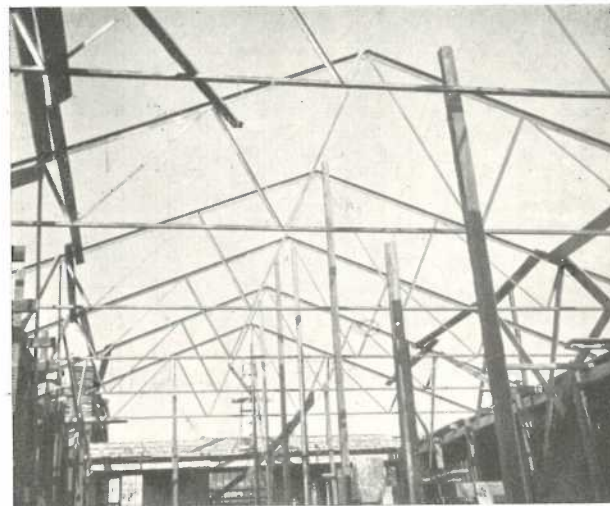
Widok na całość konstrukcji dachowej po wykonaniu.
